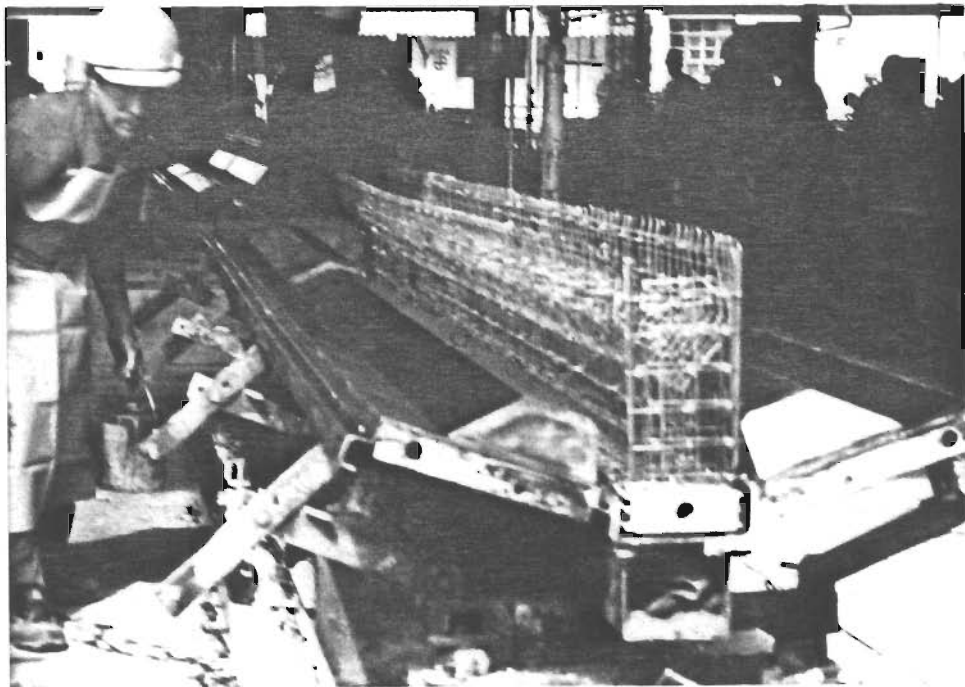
Fôrma metálica de viga de cobertura do sistema de equipamentos sociais.
